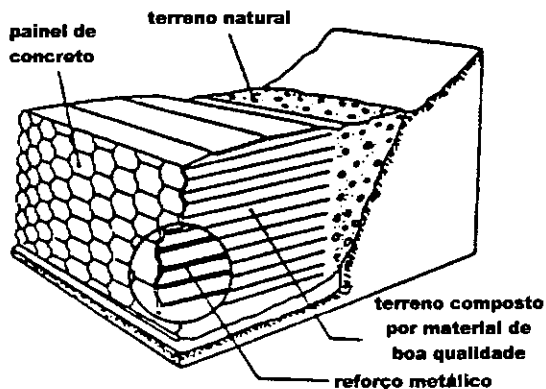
Vista esquemática de um muro de solo reforçado (apud MITCHELL e VILLET, 1987)
